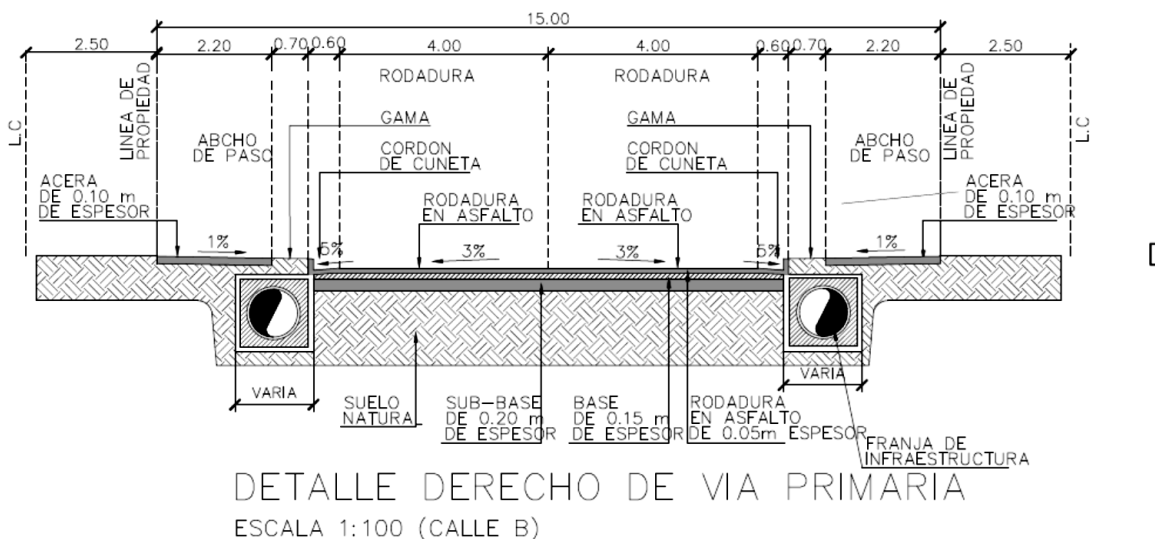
Detalle Derecho de Vía Primaria-Calle B
